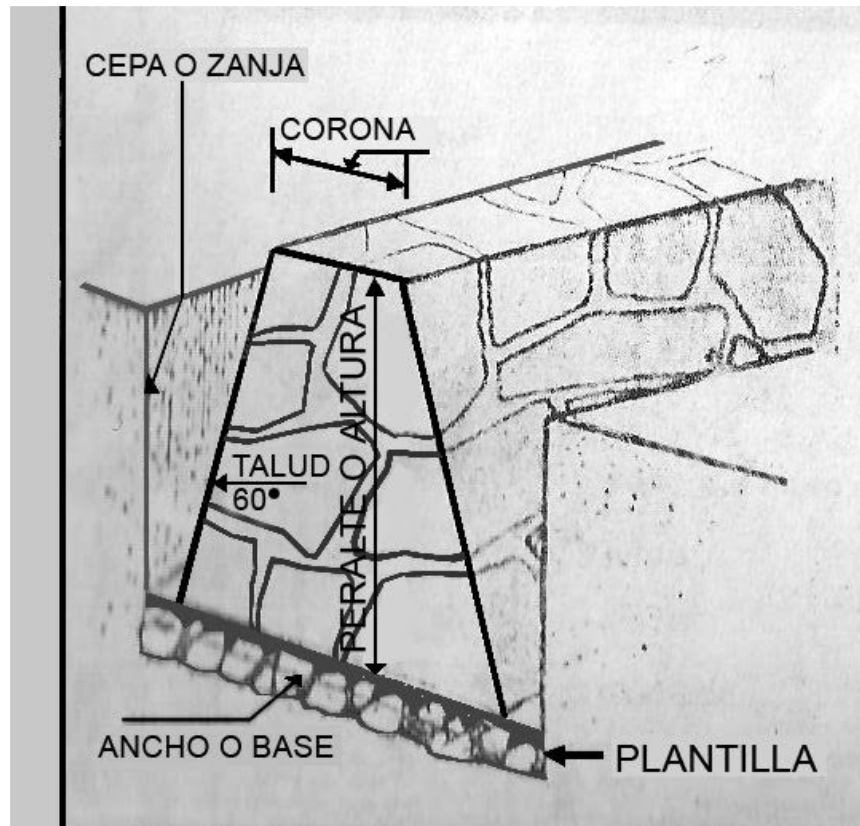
Mampostería. <https://www.arqhys.com/construcciones/cimientos-piedra.html>
